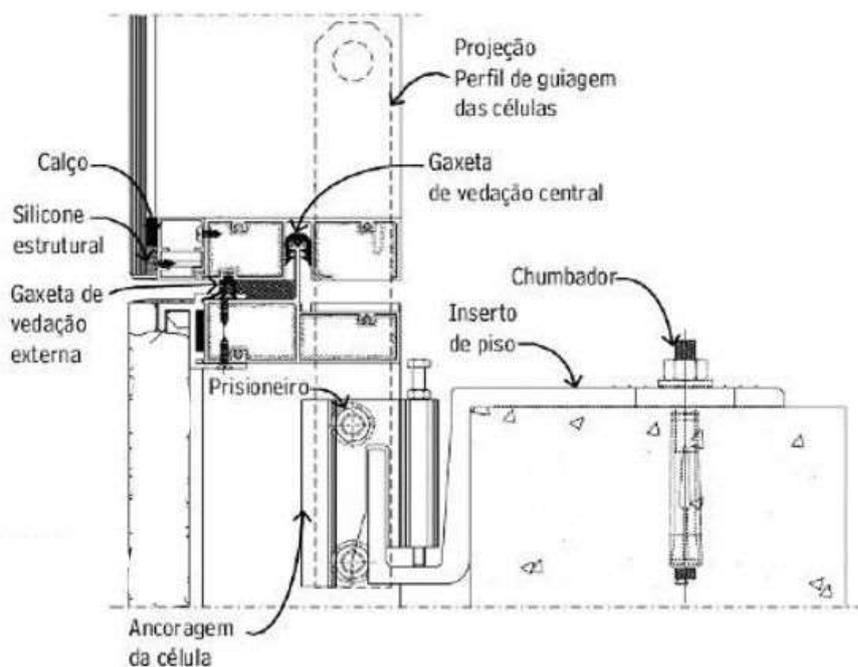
Painel instalado - Detalhe da ancoragem na viga metálica
